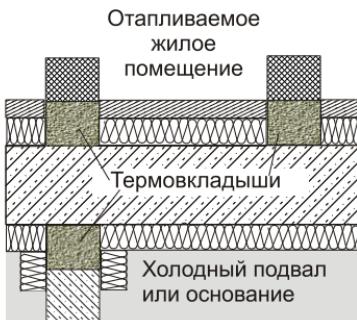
"Тепловые мостики" в месте стыка внутренних стен с фундаментными стенами и подвальным перекрытием
